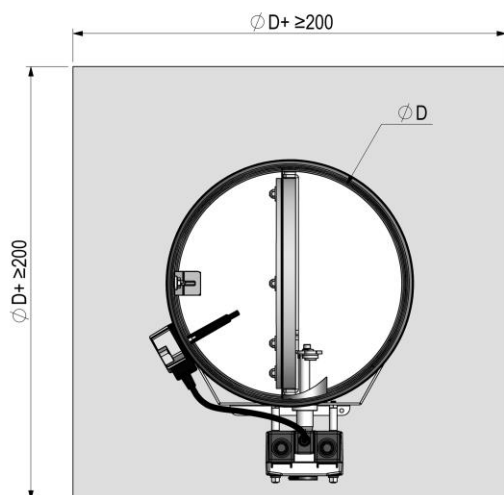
montaggio in soffitti massicci con zoccolo in calcestruzzo, vista dall'alto
